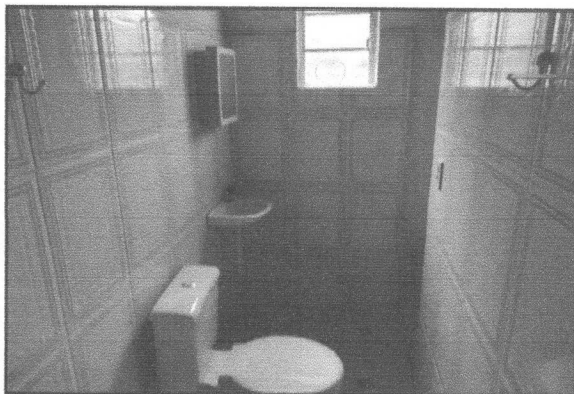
Imagem do Banheiro do pavimento térreo, com pia em louça, sanitário e piso e parede revestidos com cerâmica
